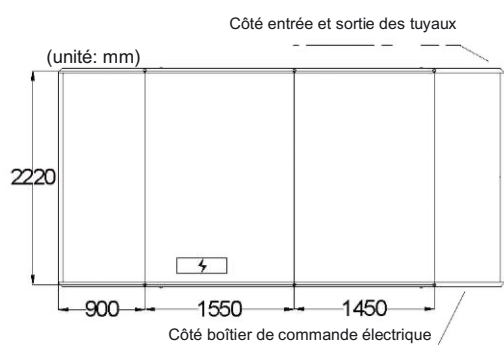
Vue de dessus du schéma des dimensions d'installation du RHAH100/105/110HVN8
